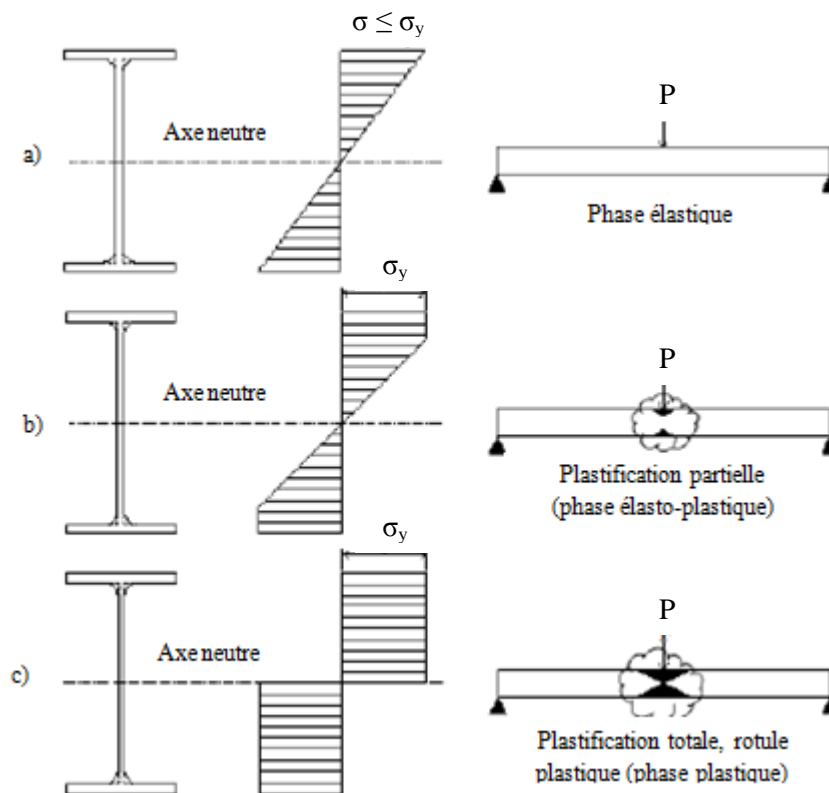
Plastification d'une section d'une poutre en acier soumise à la flexion.
